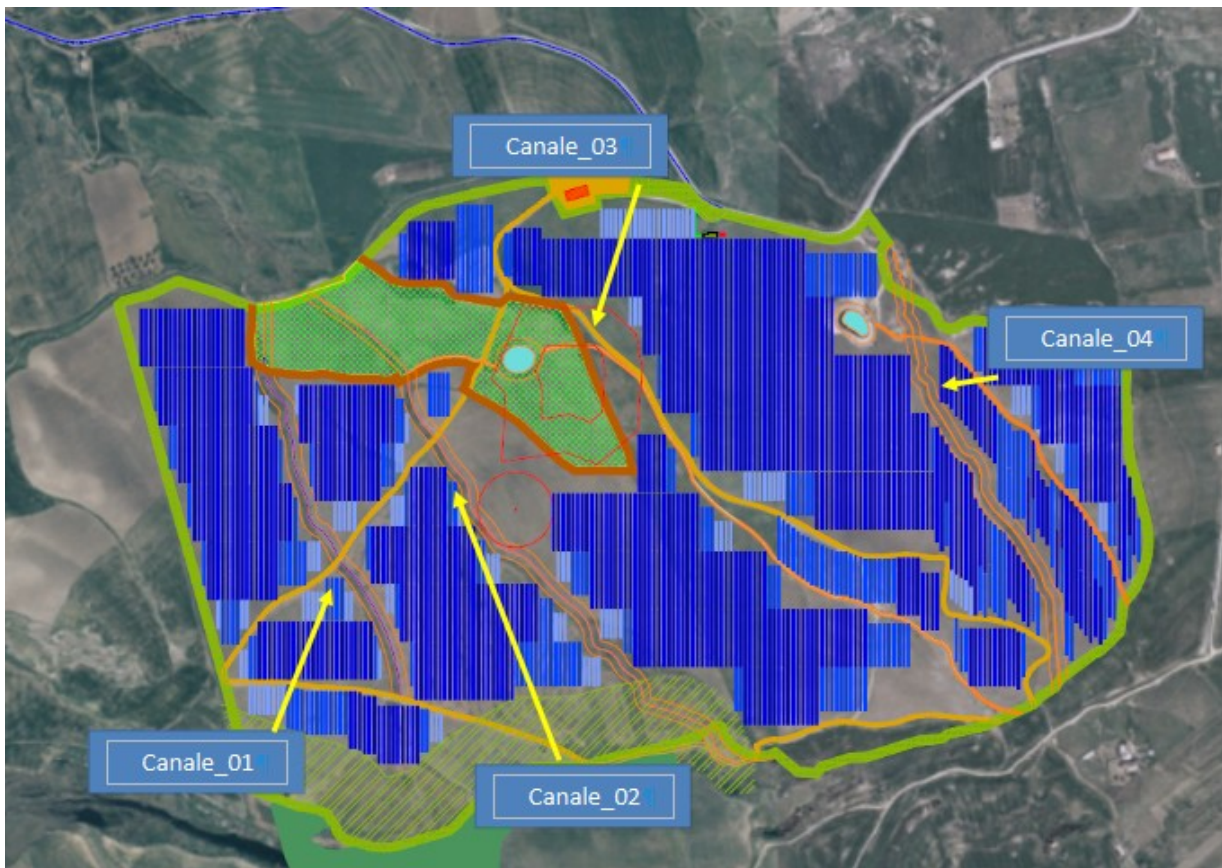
individuazione del reticolo esistente rispetto al lay - out di progetto
